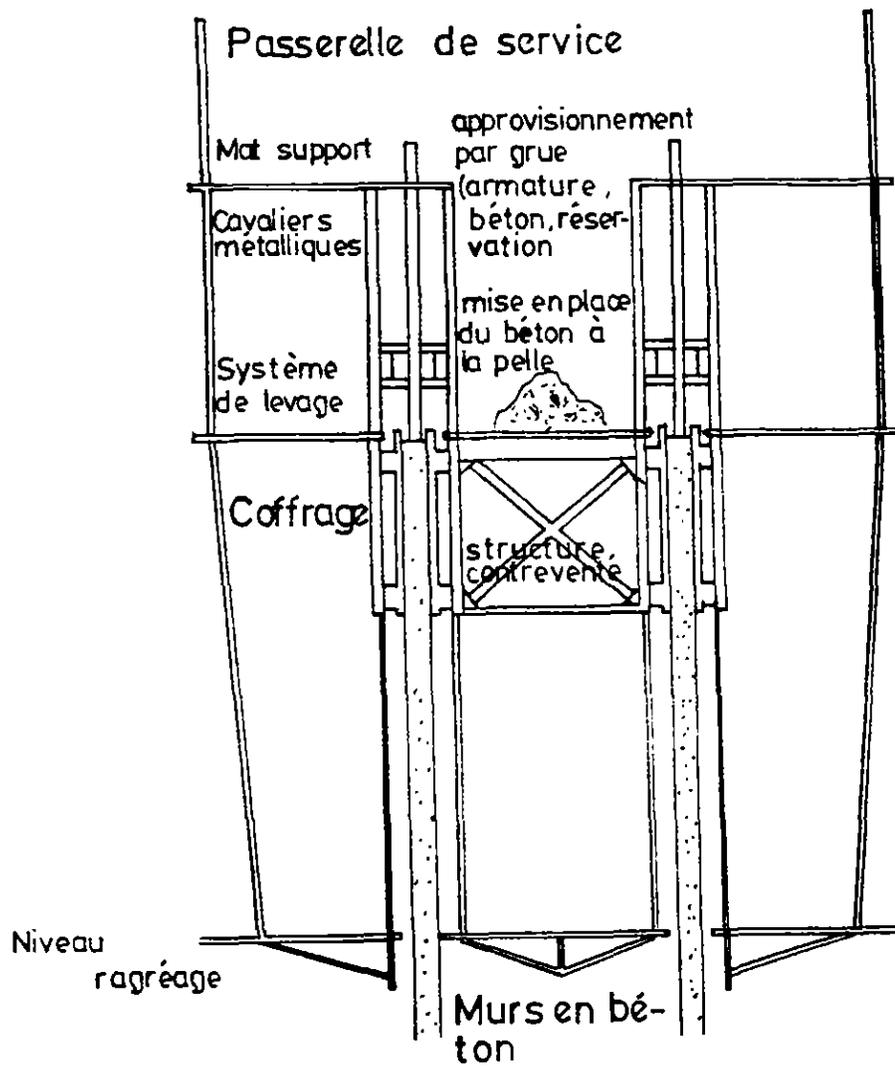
Coupe schématique d'un coffrage glissant pour des structures fermées
